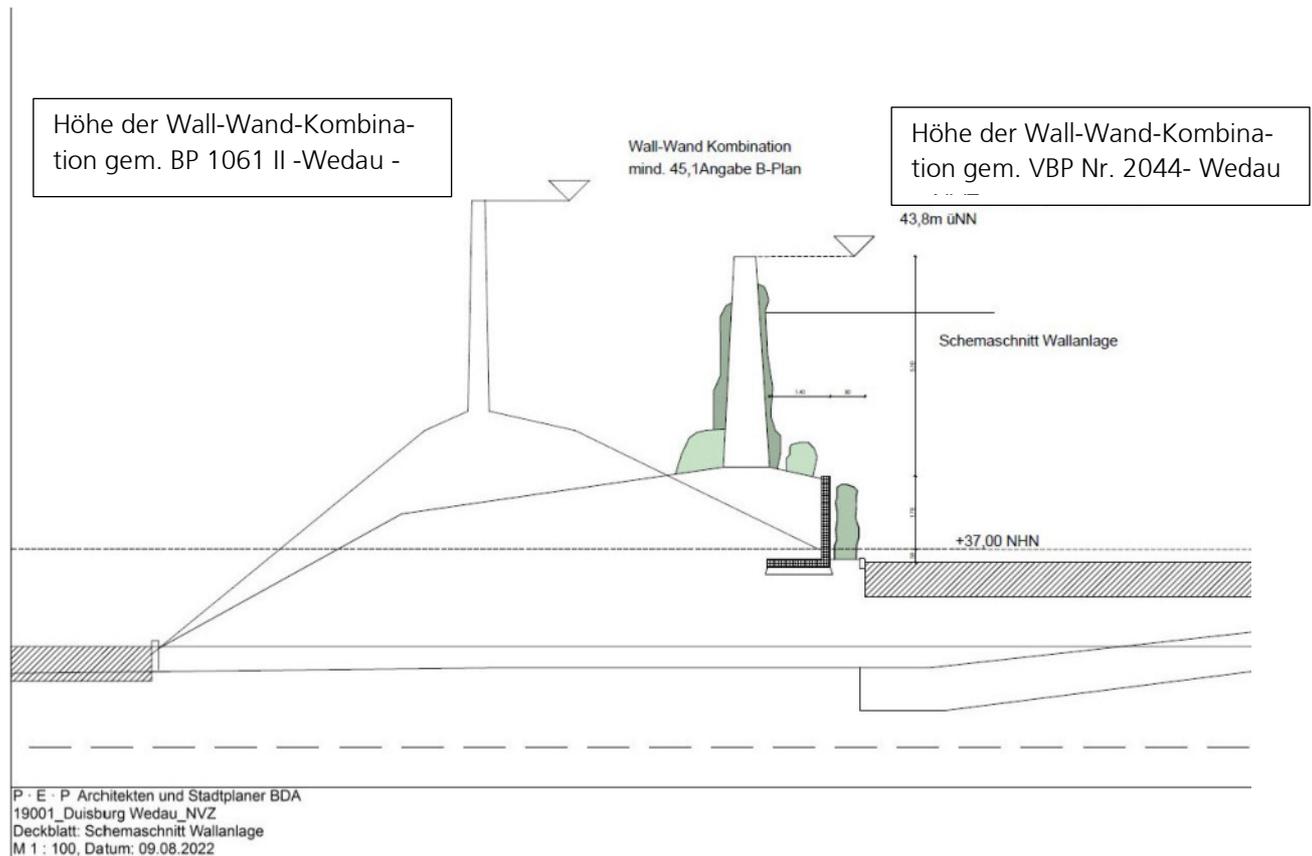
Schemaschnitt geplante Wall- / Wandkombination im westlichen Plangebiet
